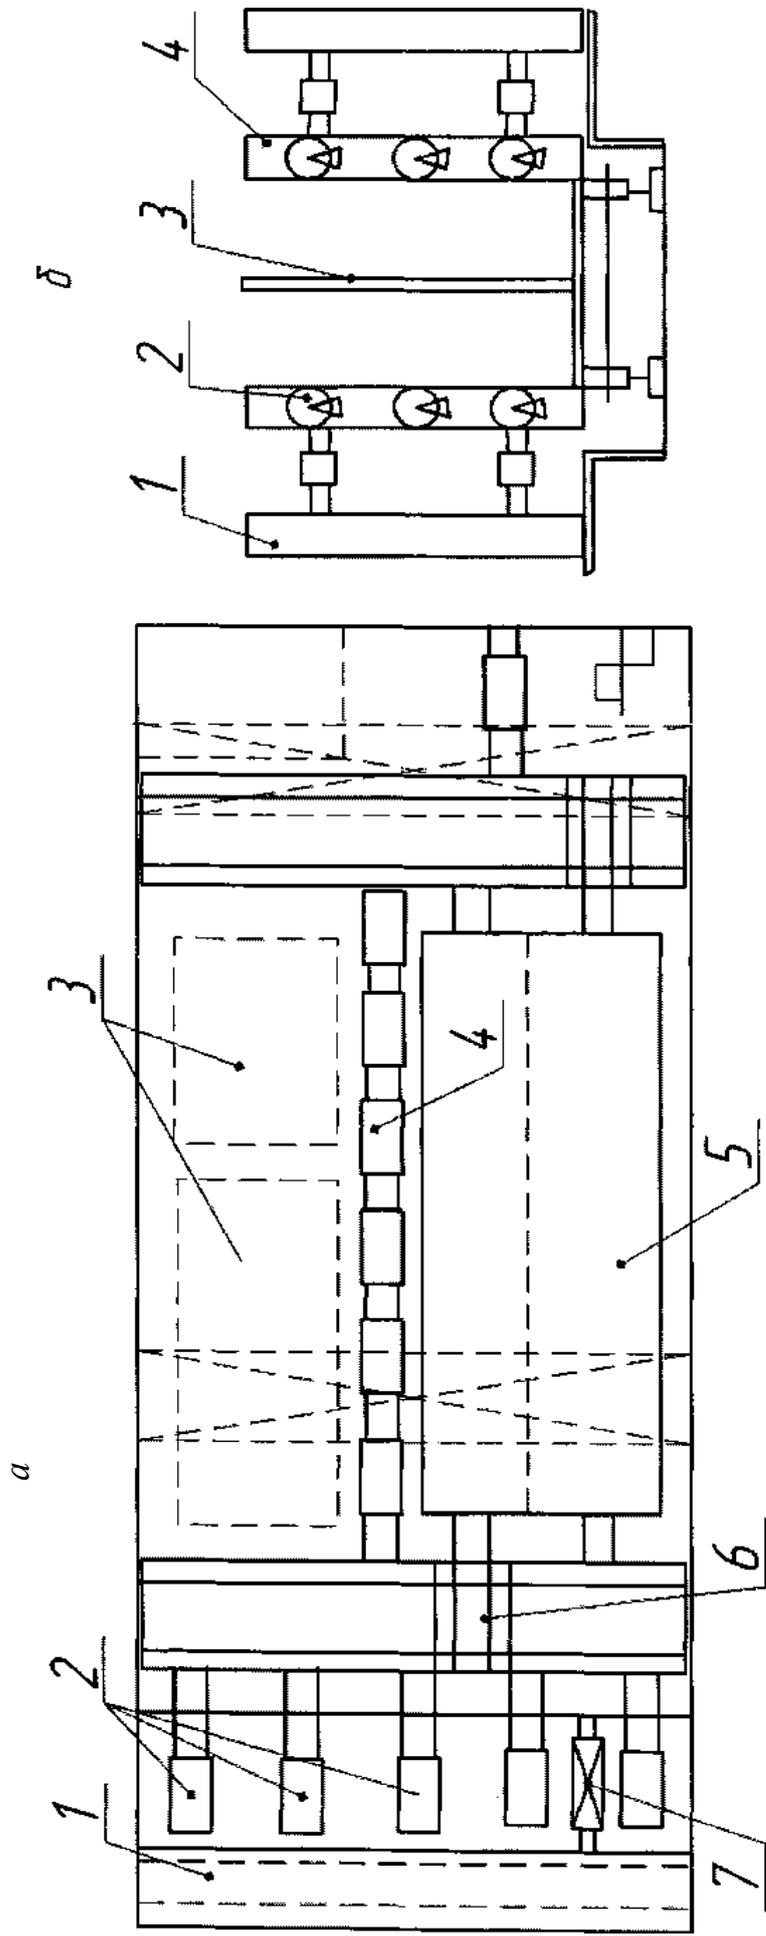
Схема кассетно-конвейерной линии изготовления панелей внутренних стен, перегородок и плит перекрытий с двухстадийной тепловой обработкой:
